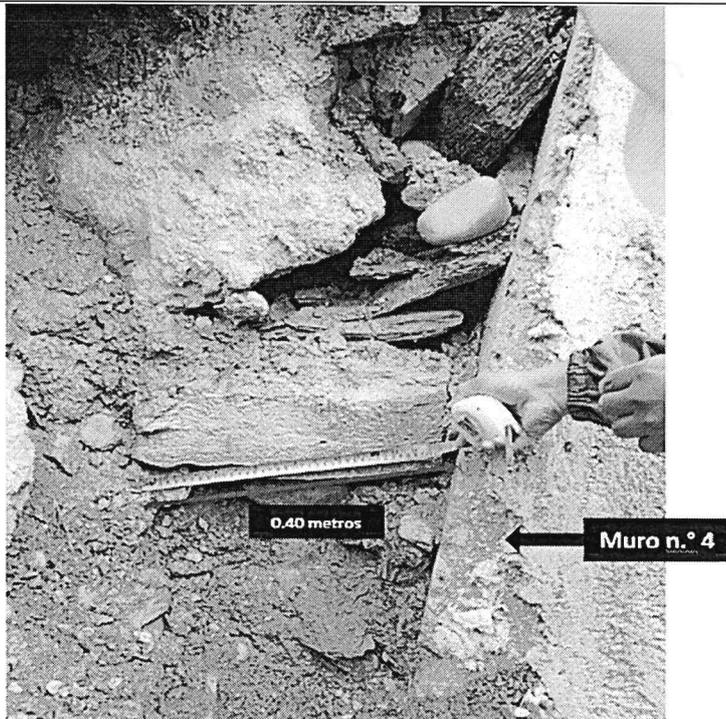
Detrás del muro de concreto armado n.º 4 (muro que no colapsó) se evidenció material no seleccionado, incluyendo piedras de hasta 0.40 metros de ancho.
